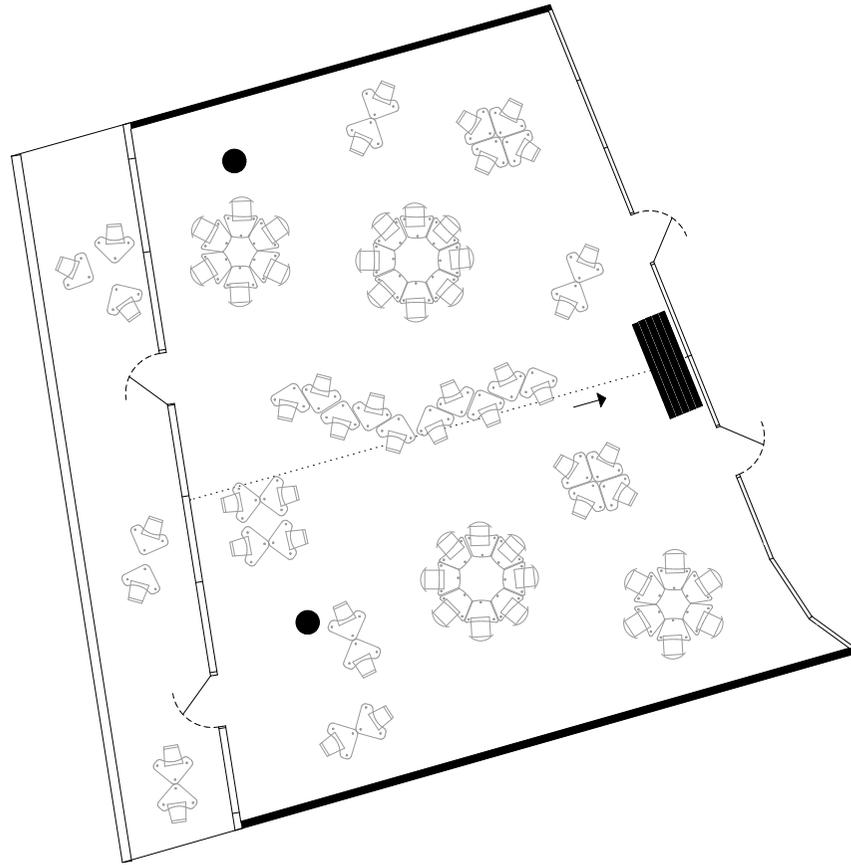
Bildungsraum mit Schiebewände - Grundriss
